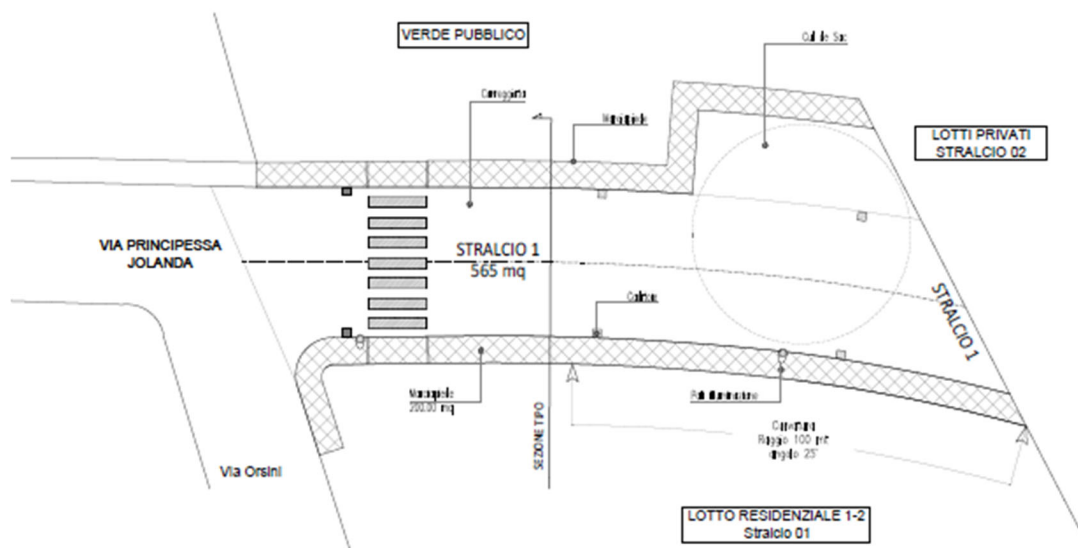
Planimetria sistemazione Via Principessa Jolanda
